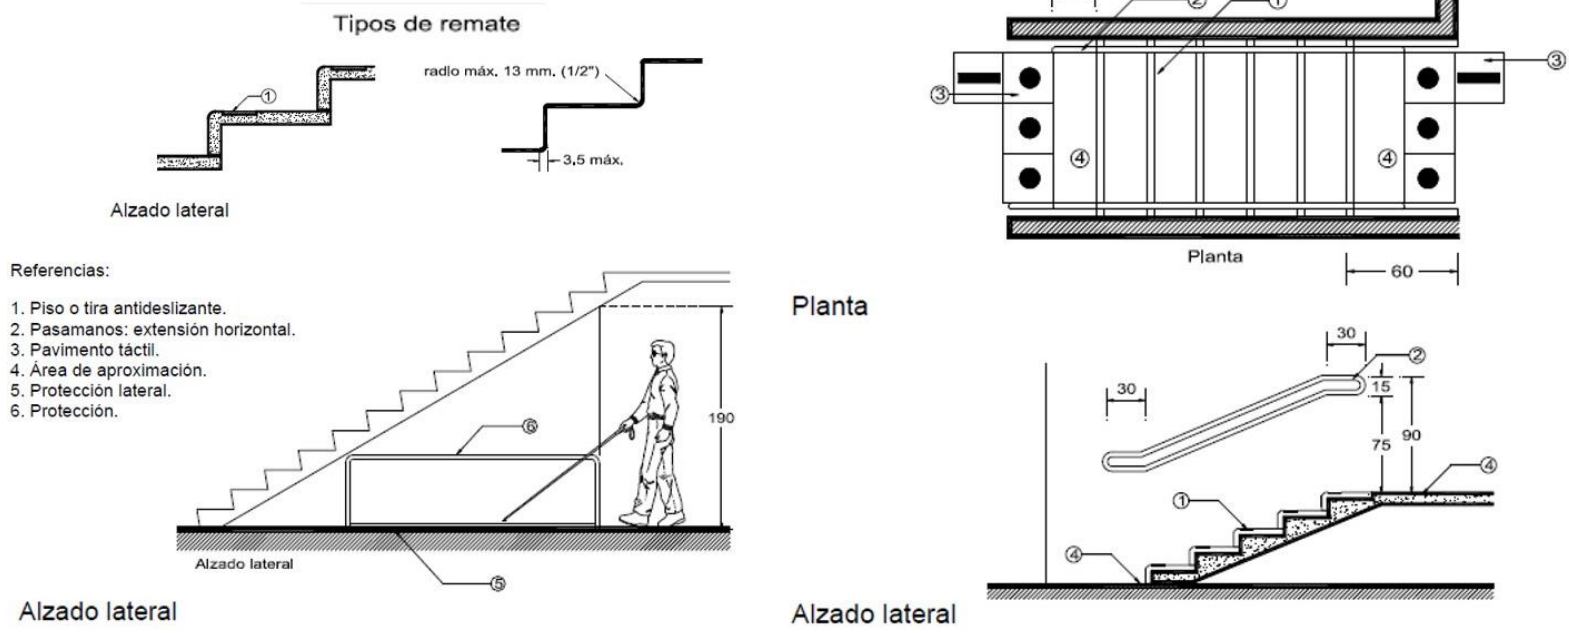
Detalles de escaleras. Diseño accesible. (MTA.SEDUVI).
